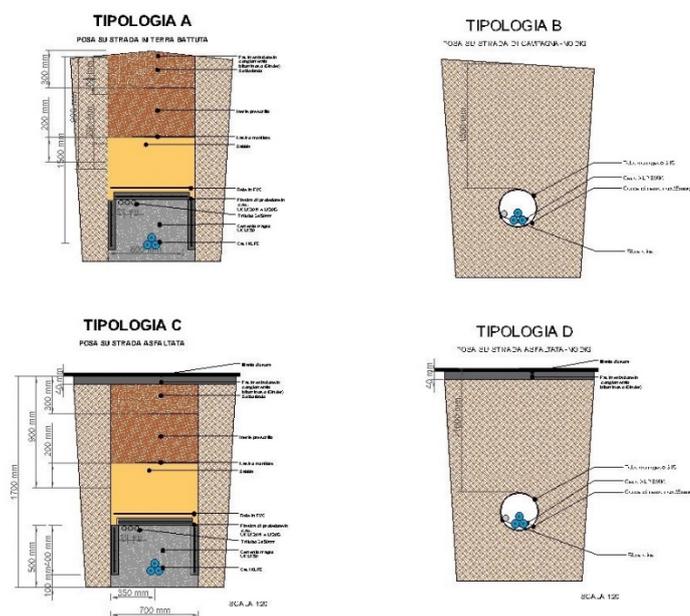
Particolare sezione tipo cavo interrato AT e particolari della sezione stradale
